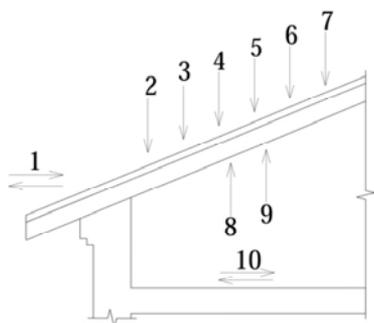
Схема приложения нагрузок и воздействий на кровлю. 1 - Ветровая горизонтальная нагрузка; 2 - постоянная вертикальная нагрузка; 3 - временная вертикальная нагрузка (снеговая, эксплуатационная); 4 - температура наружного воздуха; 5 - солнечная радиация; 6 - атмосферные осадки; 7 - химические агрессивные вещества, содержащиеся в воздухе; 8 - диффузия водяного пара; 9 - температура воздуха чердачного пространства; 10 - движение воздушных потоков в чердачном пространстве.
